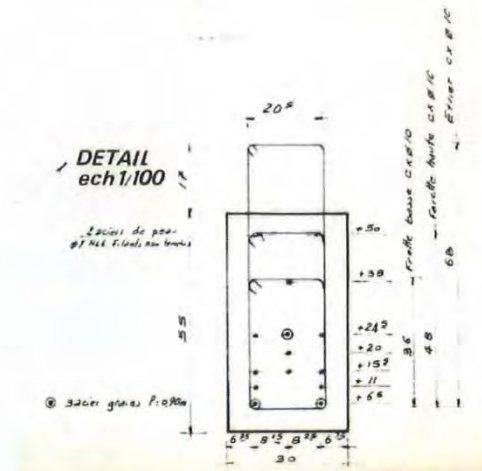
Plan de ferrailage de la poutre précontrainte (Extrait des plans d'archive)
